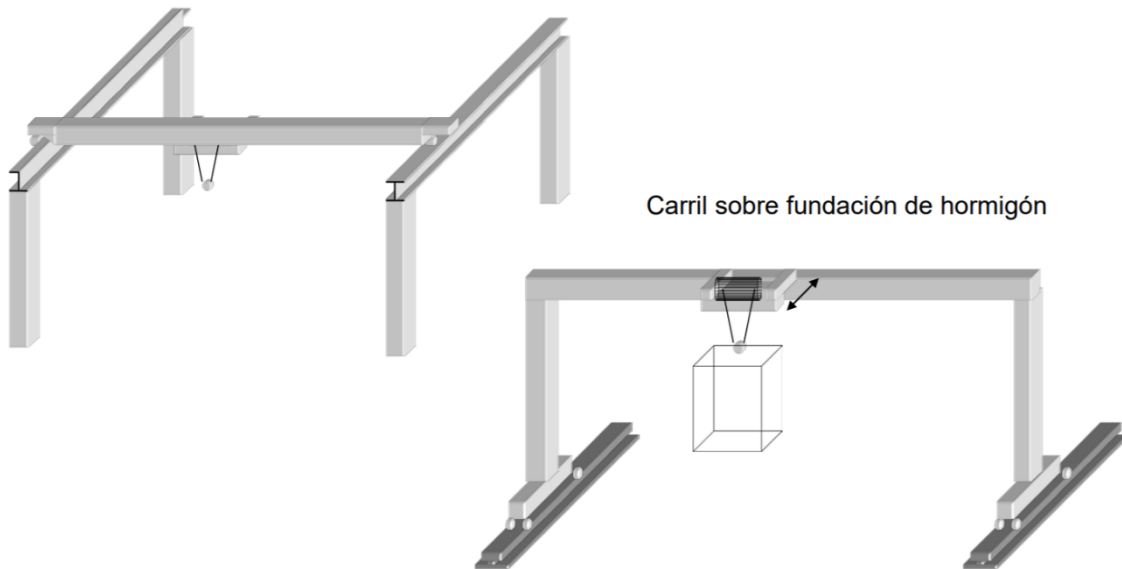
Carril elevado (izquierda). Carril sobre cimentación de hormigón (derecha)
